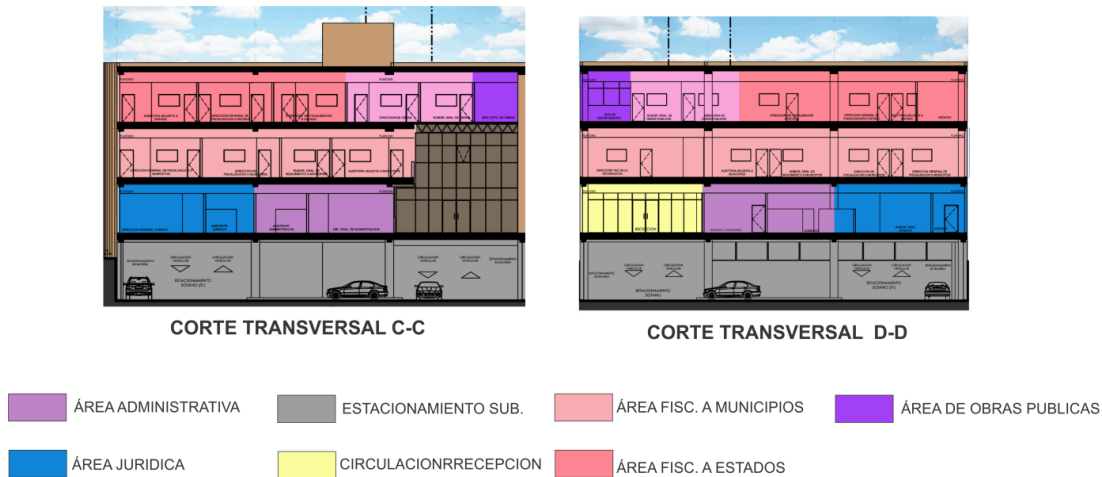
Corte transversal C-C' y D-D' (Primer Propuesta). Autor: Eva Zavala
